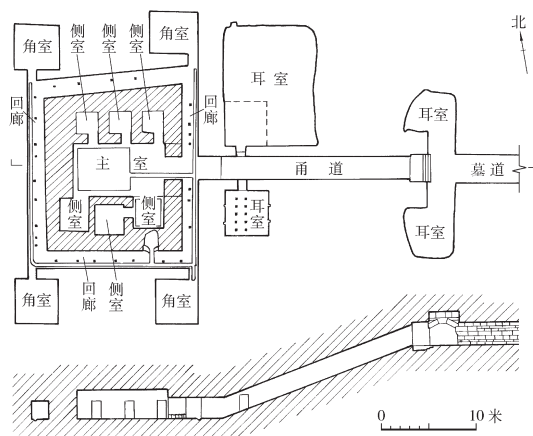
河南省永城保安山 1 号墓平·断面图 (1/800)
